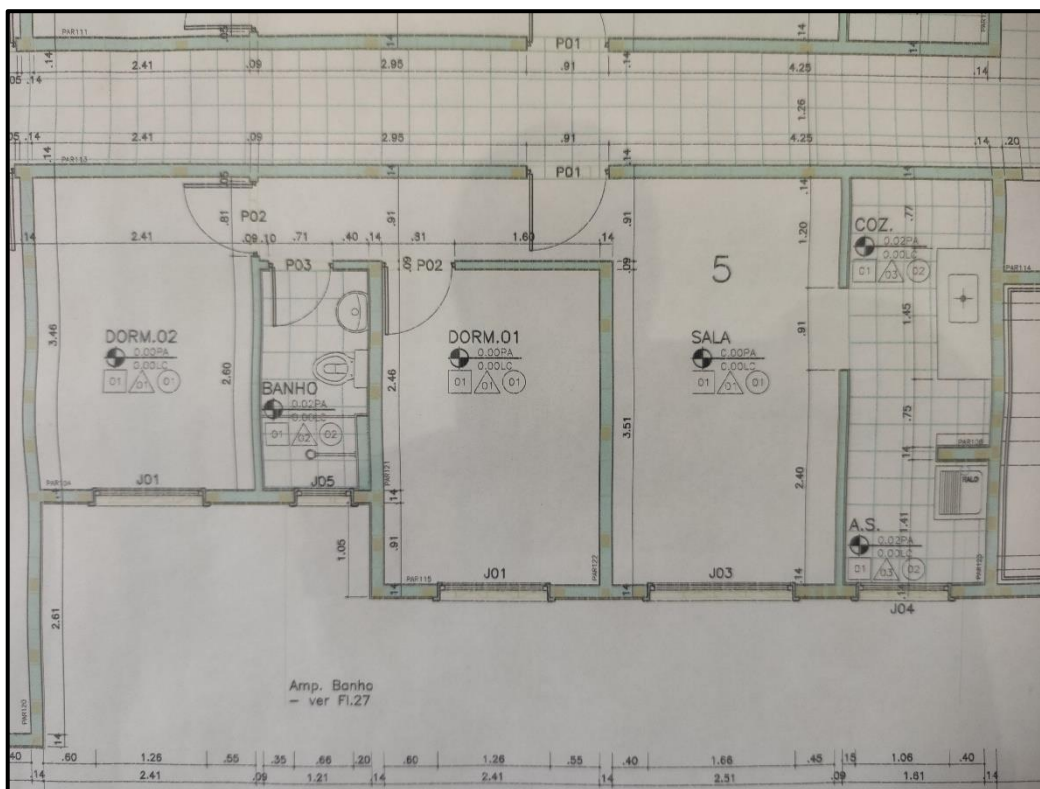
Planta do pavimento-tipo das torres (blocos) do condomínio
